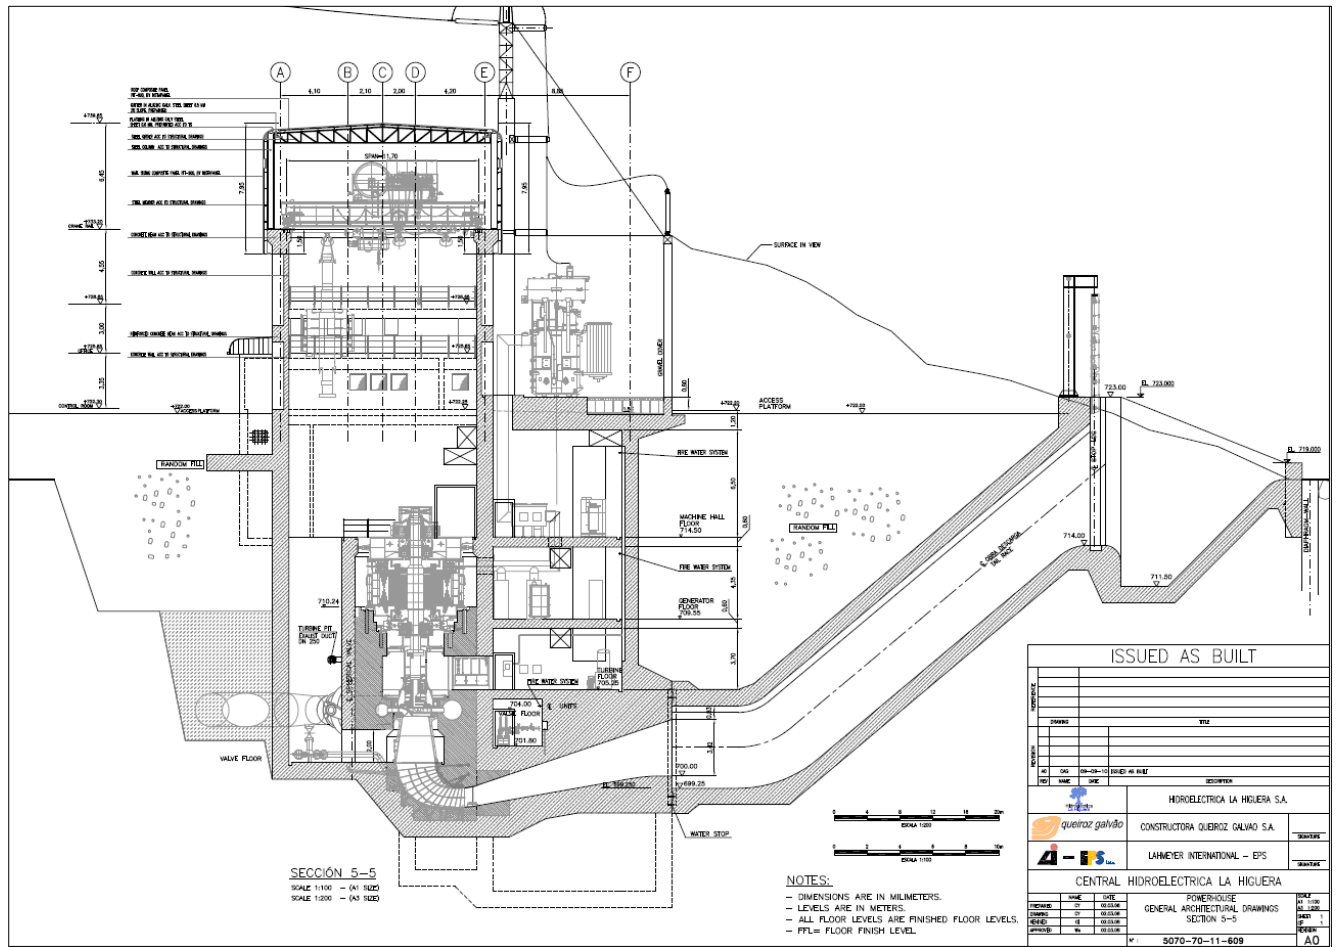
Plano de disposición de planta (Casa de máquinas)
